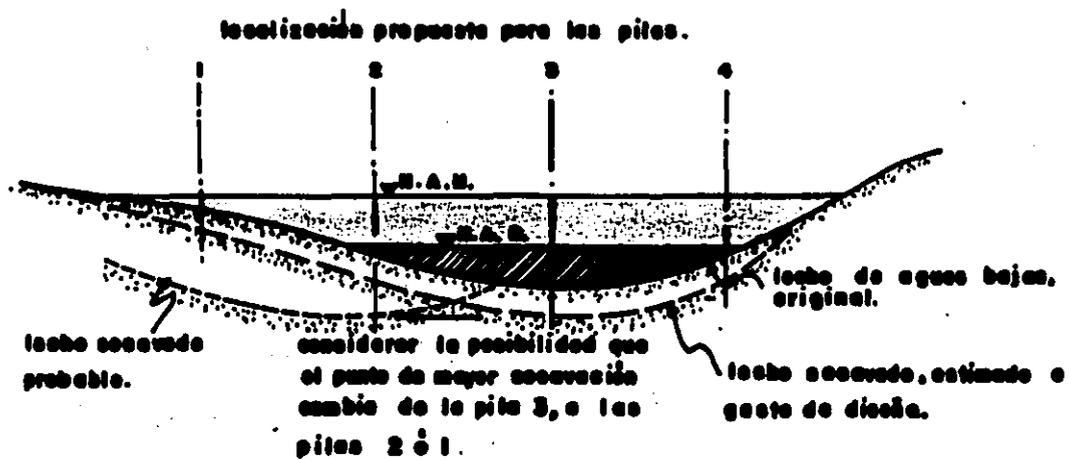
Sección transversal hipotética de un río, ilustrando el problema de provocar un cambio en la posición de la mayor secavación.
